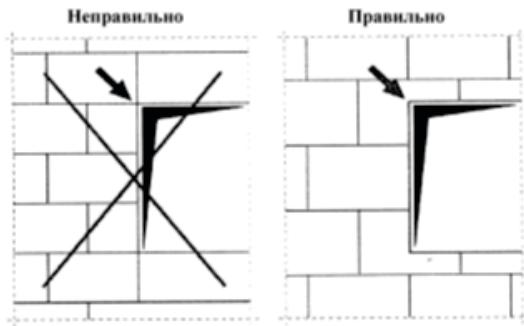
Укладка теплоизоляционных плит по периметру проема
